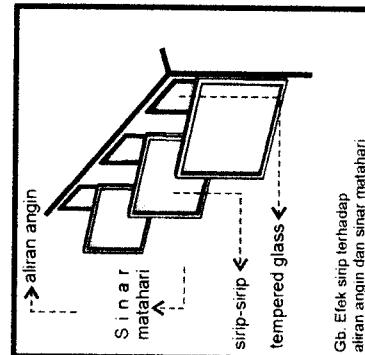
b Detail bangunan (sun shading)+analisis
